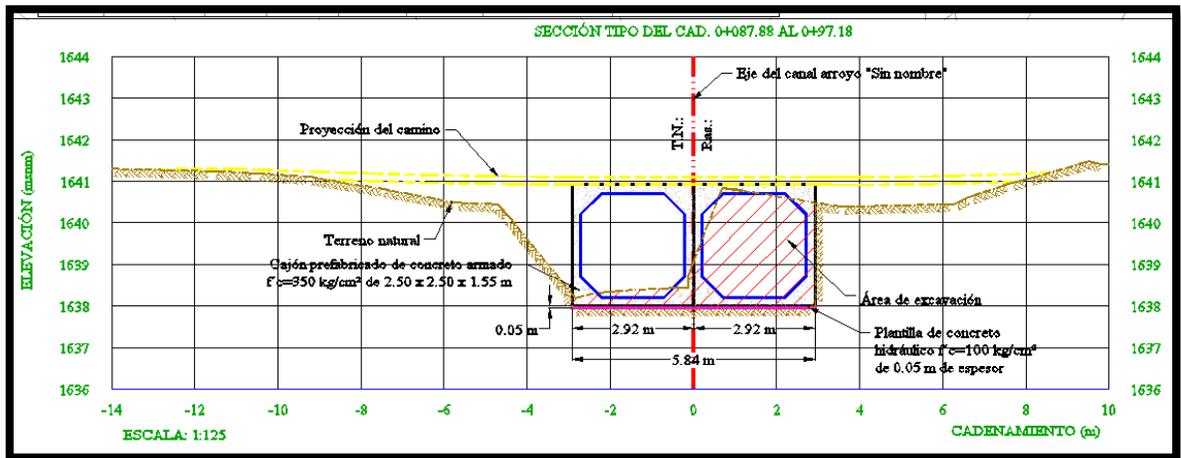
Sección tipo de la alcantarilla a construir sobre el arroyo sin nombre.
